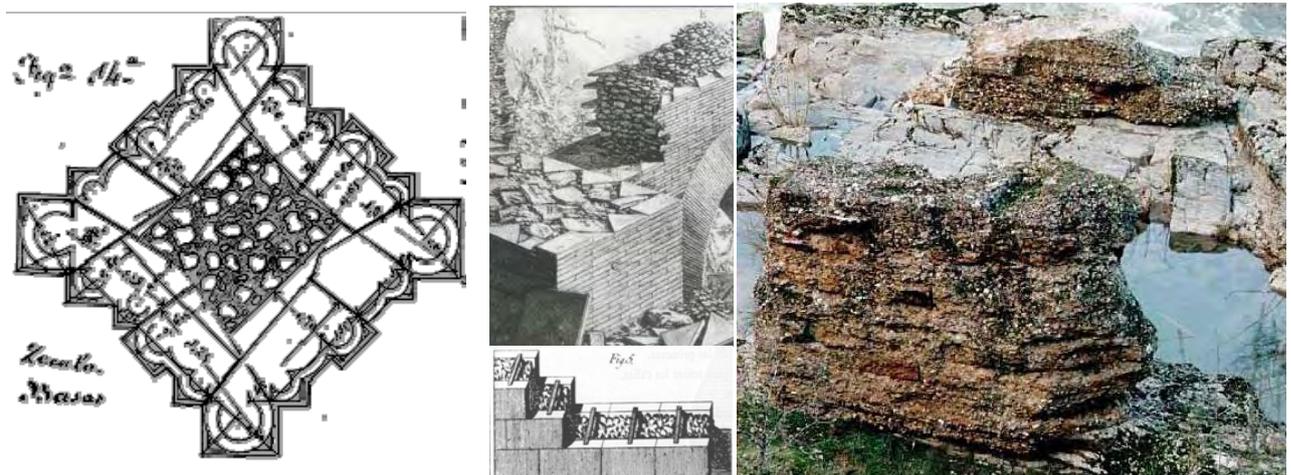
Izquierda, sección transversal de las pilas de la Catedral de León. Demetrio de Los Ríos (s. XIX). Derecha, configuración típica de muros romanos y restos de pilas de hormigón de las que ha desaparecido la hoja exterior de sillería.
